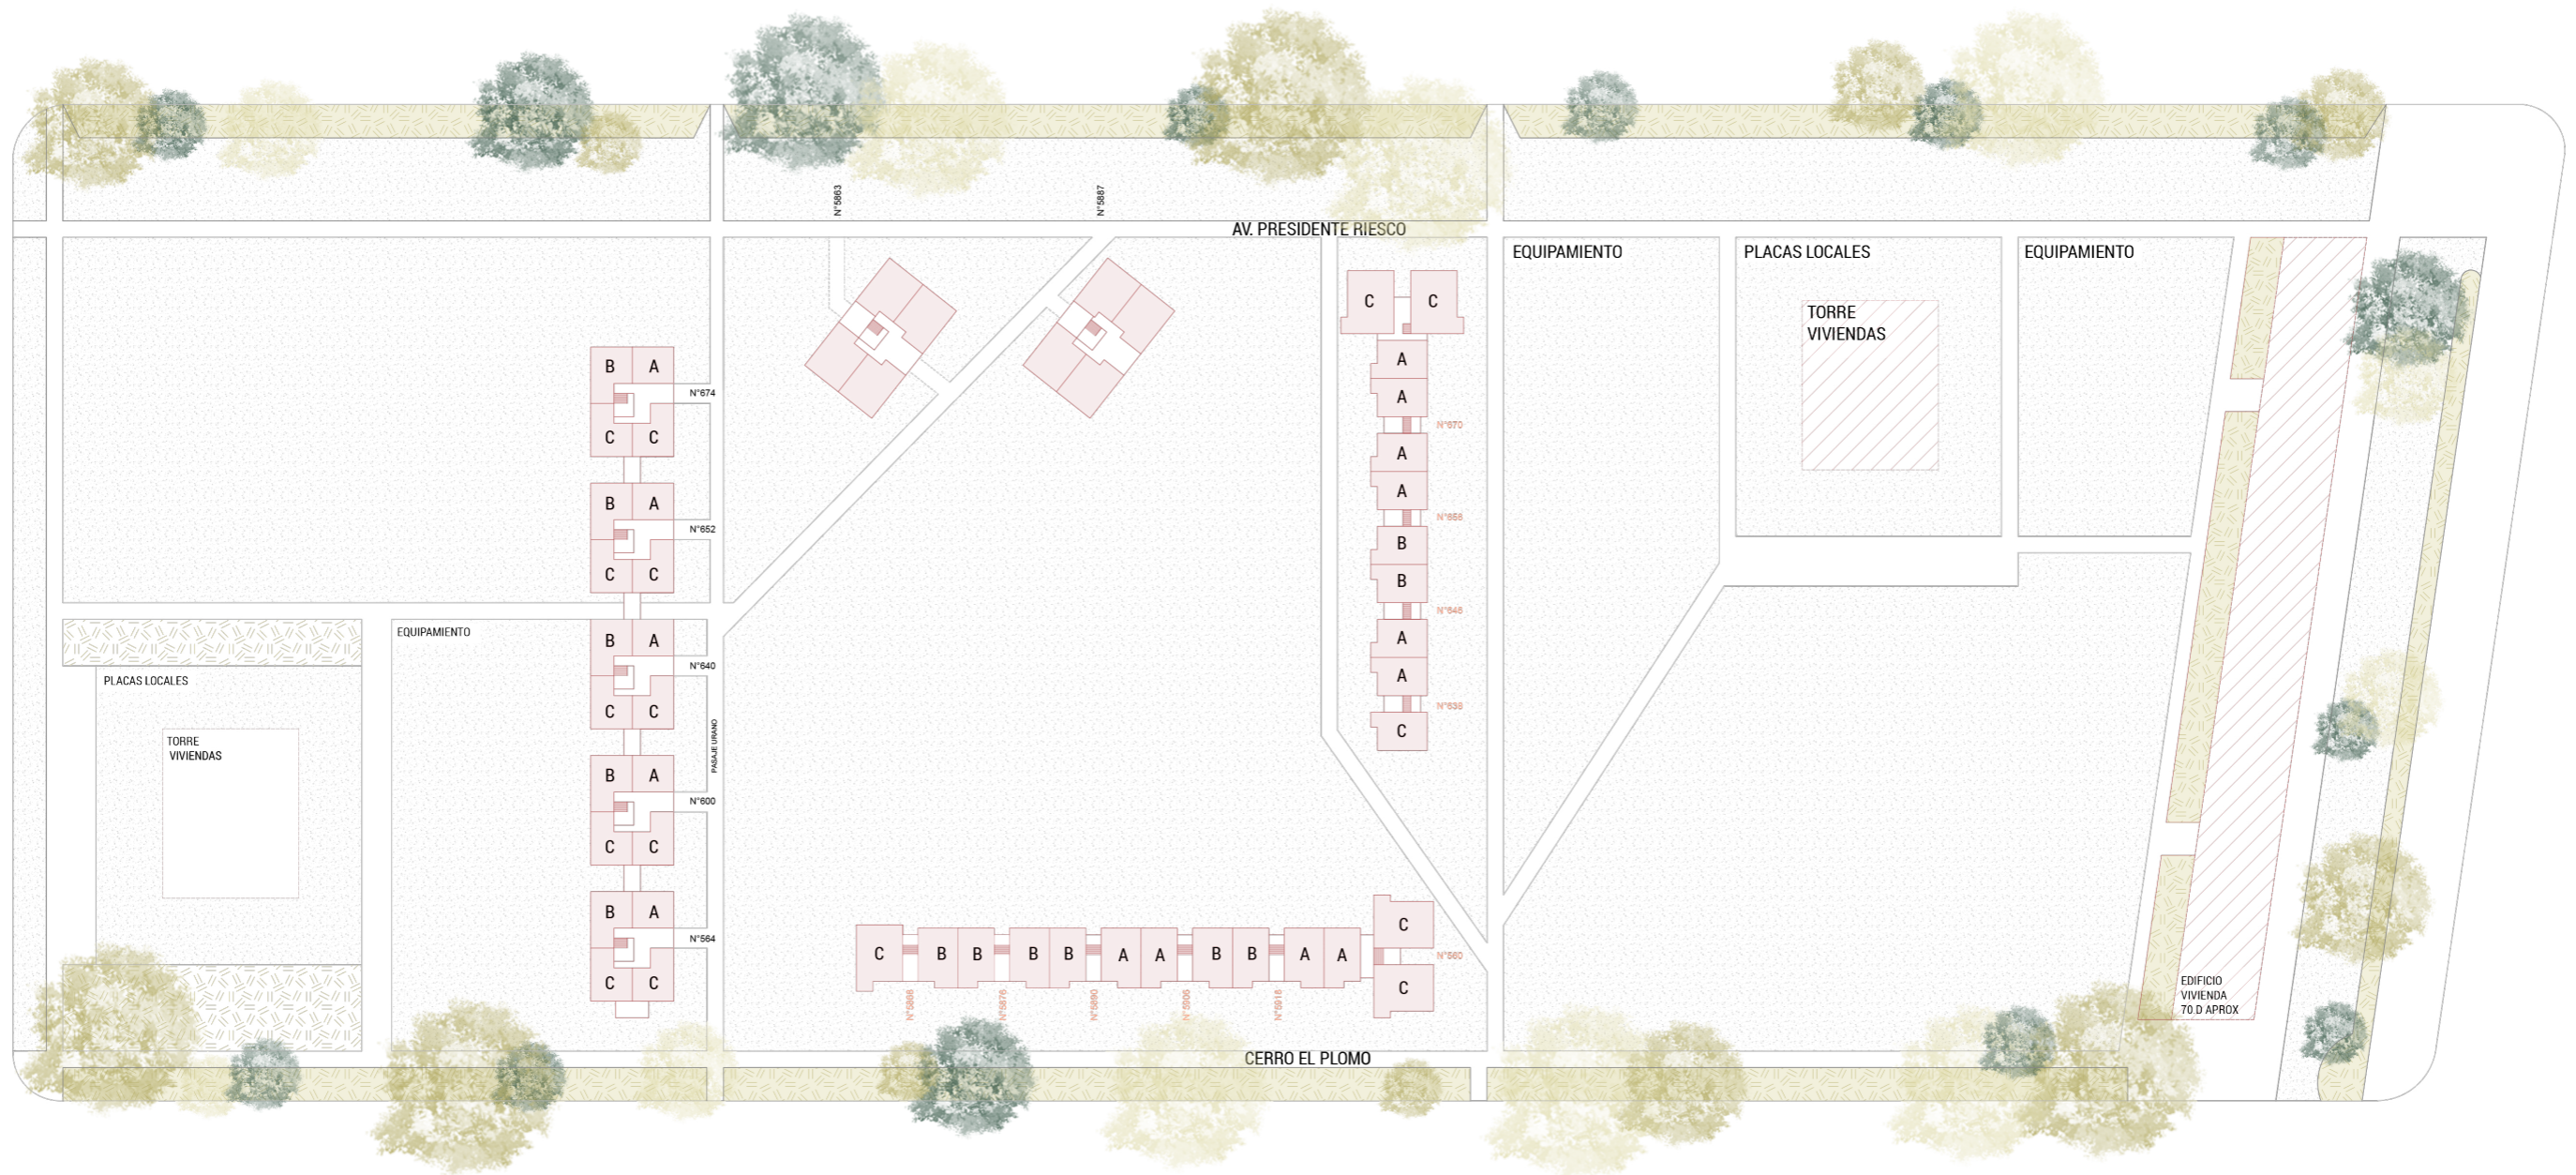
Planta esquemática general Villa San Luis | Esc. 1:100
